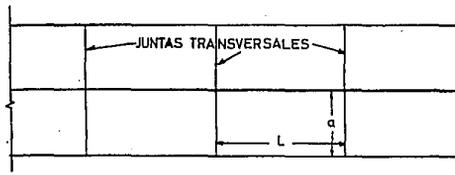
JUNTA DE CONTRACCION CON LOSAS A TOPE
